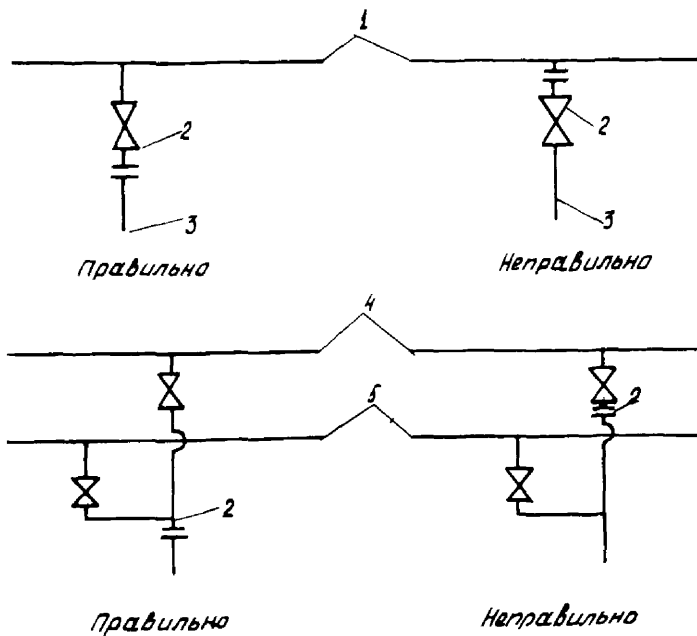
Установка изолирующего фланца на отводах от магистральных трубопроводов:
